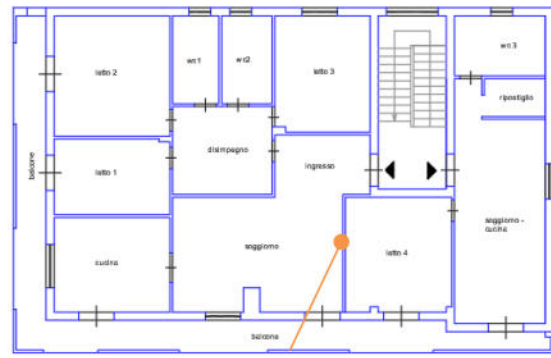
LOTTO 1 planimetria rilevata piano terra
